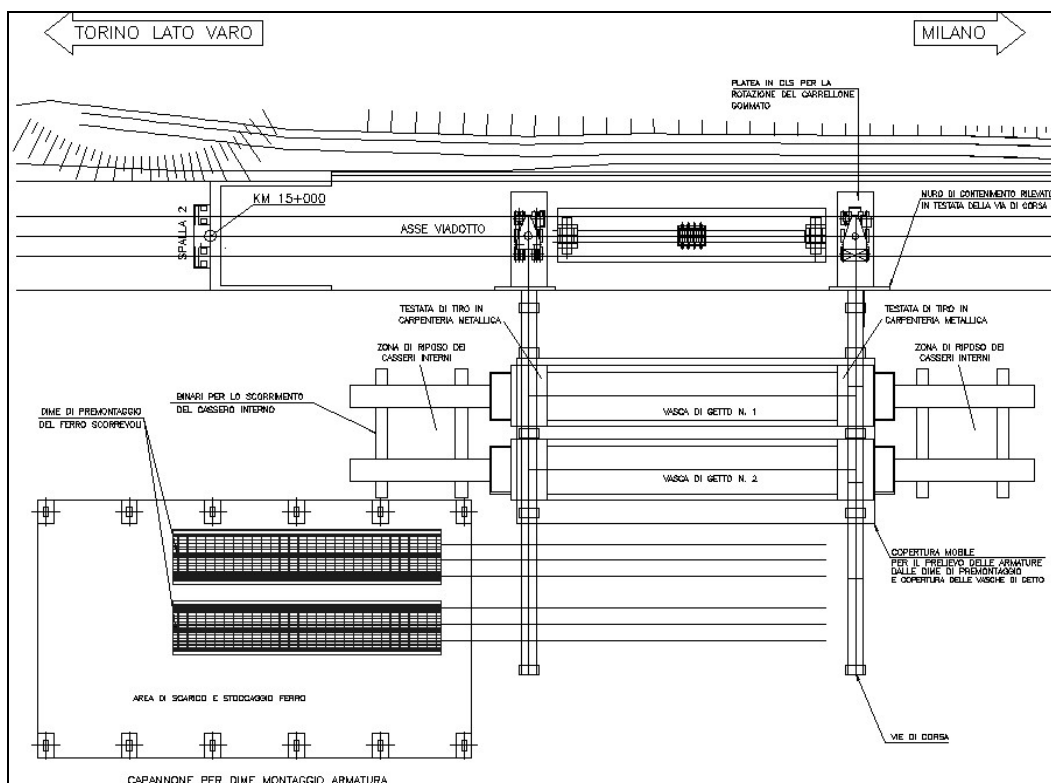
PIANTE DELL'IMPIANTO DI PREFABBRICAZIONE DI CHIVASSO.
